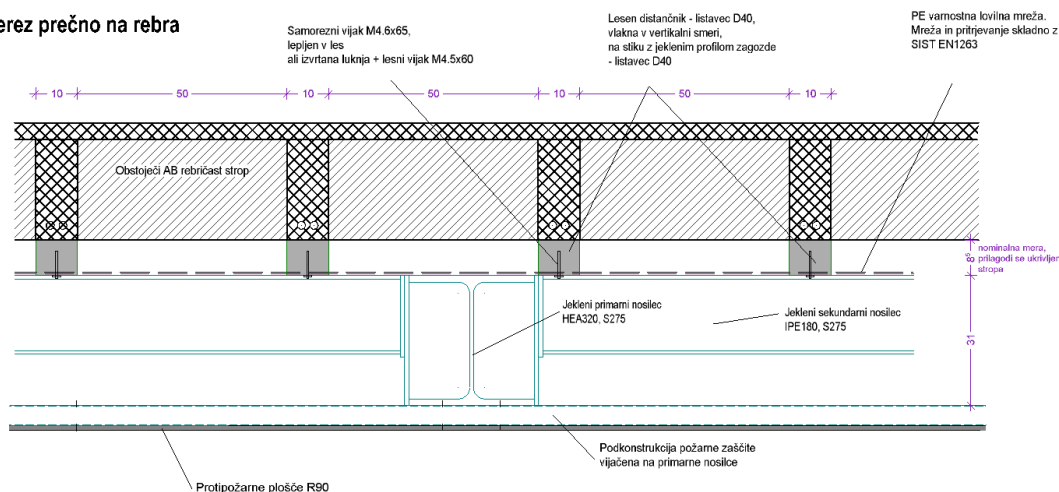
Primer lovilne PE mreže in shema pritrdjevanja na jekleno konstrukcijo
